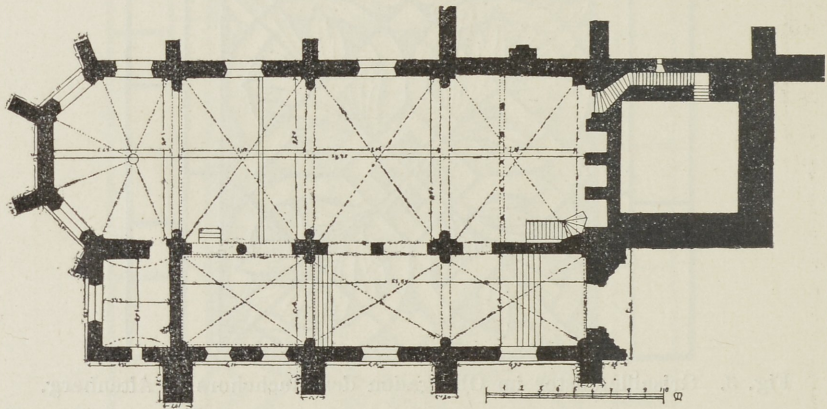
Hochelten. Grundriss der Abteikirche.
